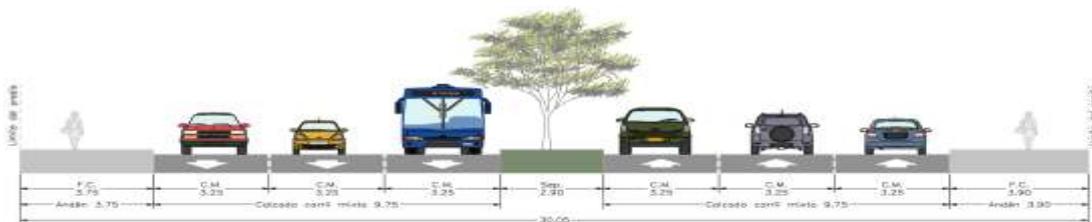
Sección Típica sobre la Calle 1 entre KR 27y Av. Caracas - Fuente: Elaboración Propia 2017.
